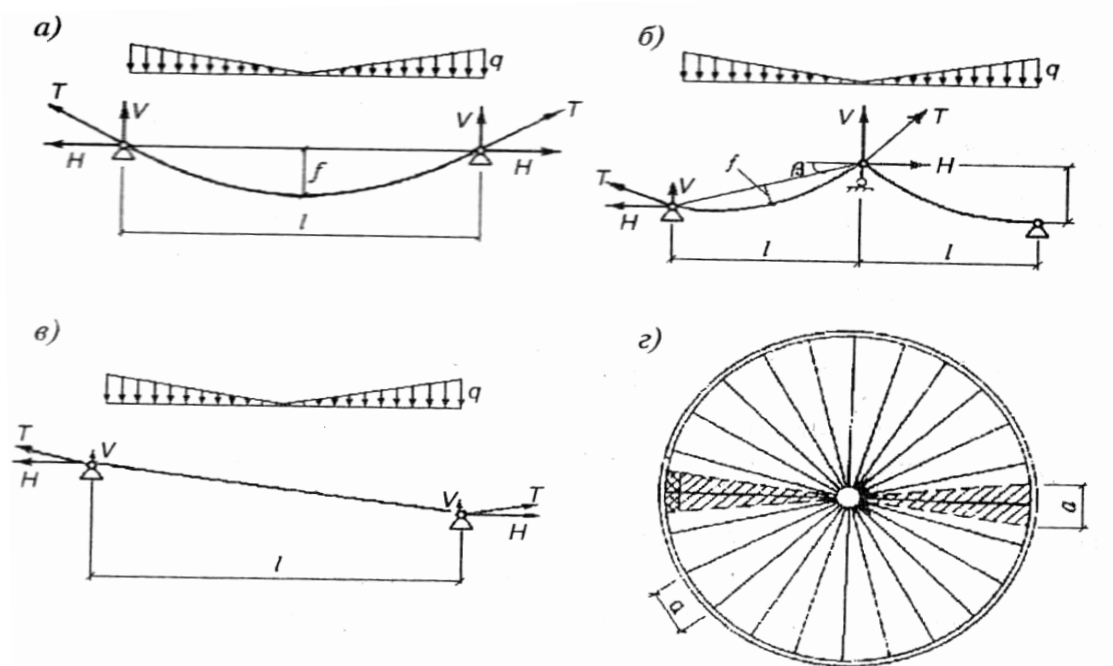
Расчётные схемы нитей в круглых покрытиях: а – вогнутых; б – шатровых; в – спиральных; г – грузовая площадь
